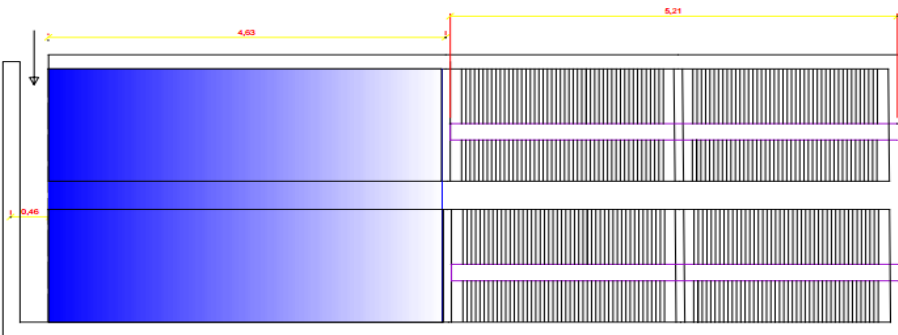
VISTA EN PLANTA FLOCULADOR
